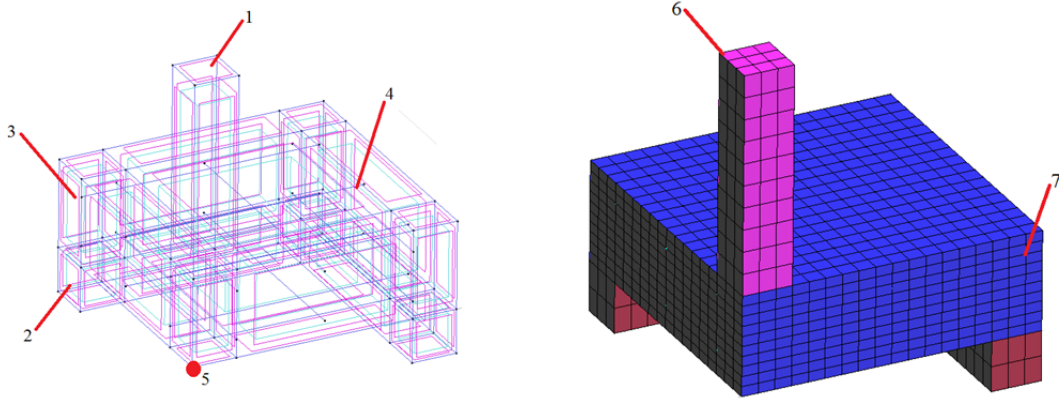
3D (слева) и КЭ (справа) модели для численных исследований с использованием ПК АТЕНА: 1 – колонна; 2 – опорная конструкция; 3 – плита перекрытия; 4 – арматурные стержни; 5 – точка мониторинга перемещений вдоль вертикальной оси; 6 – место приложения нагрузки; 7 – закрепление образца от смещения из плоскости симметрии
